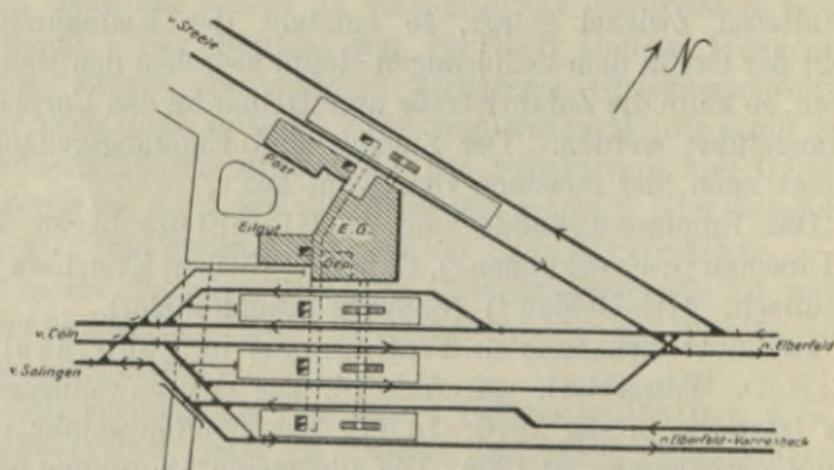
Grundriß des Empfangsgebäudes Vohwinkel (verzerrter Maßstab).
